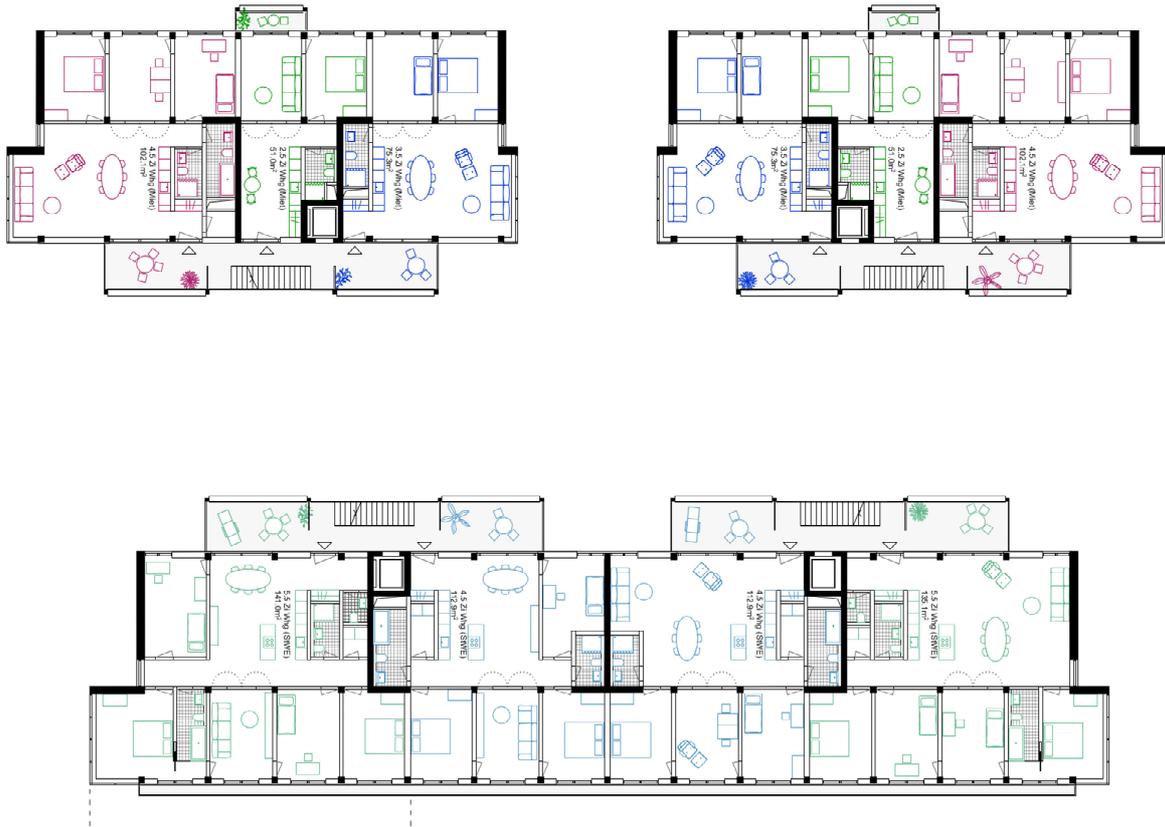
Hallo, Nachbar!: Grundriss Regelgeschoss
